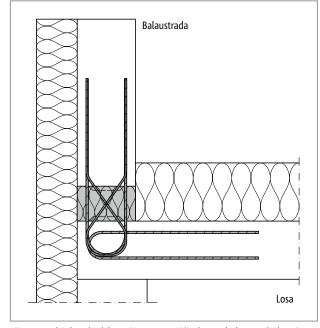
Schöck Isokorb® XT tipo A: Conexión de una balaustrada (XT tipo
